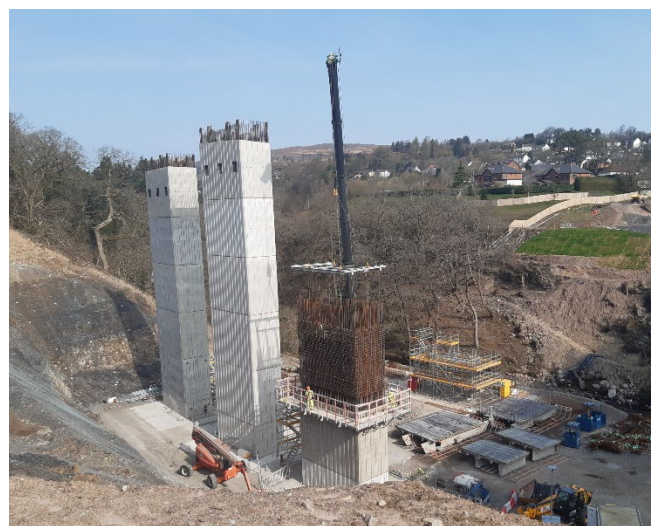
Montaje de armadura en una trepa durante la construcción de las pilas.
